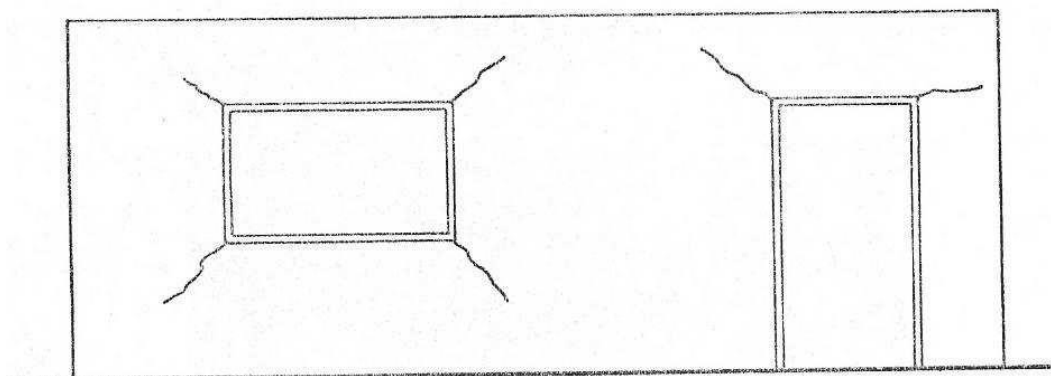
Fissuras pontuais causadas por sobrecarga vertical.
